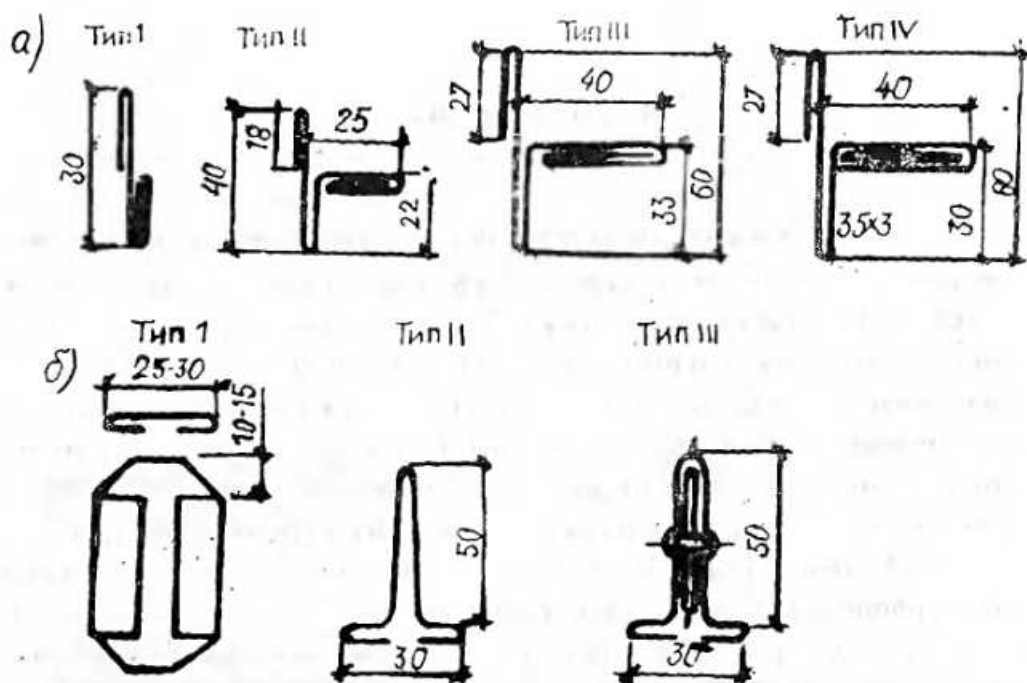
Деталі планково-рейкового з'єднання: а) планки ; б) рейки
